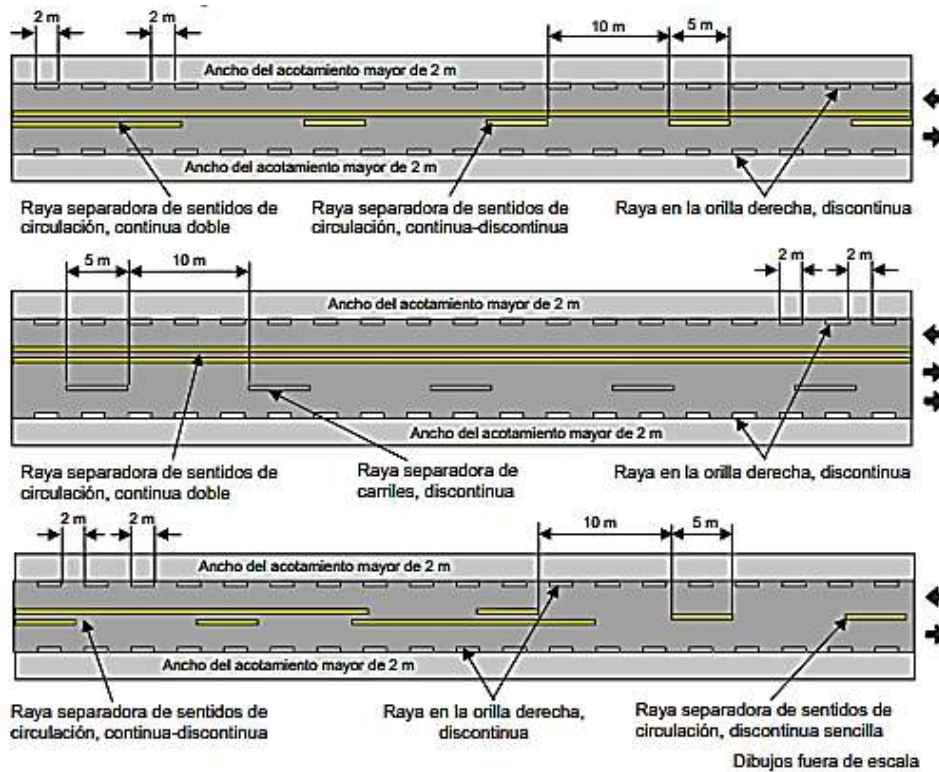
Marcas en el pavimento en carreteras con ancho de calzada de hasta 6.5m
